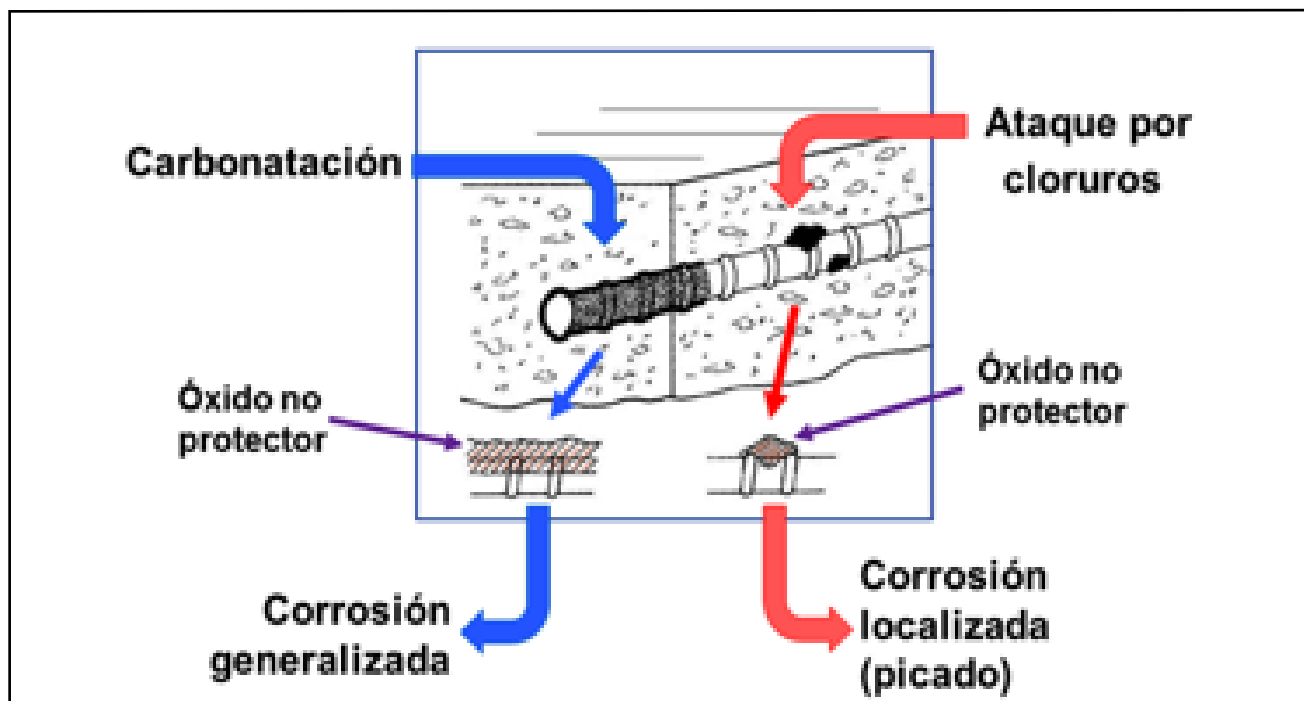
Tipos de corrosión más frecuentes en estructuras de hormigón armado, origen y consecuencias.
